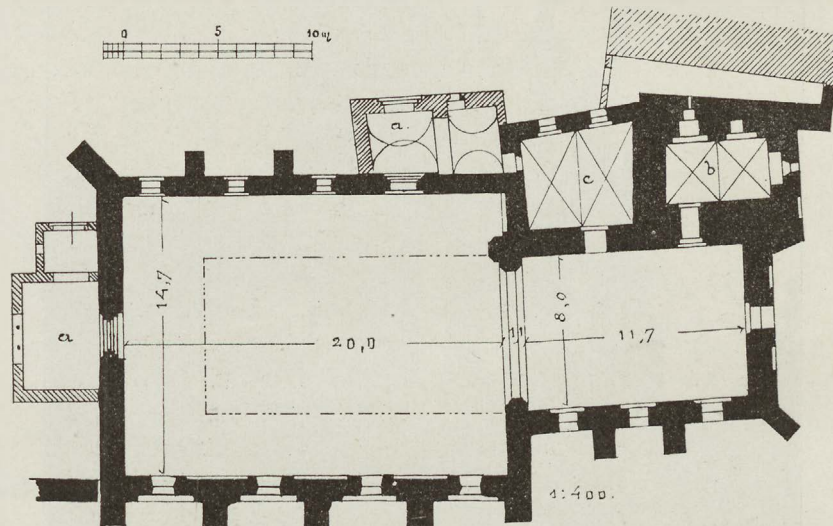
Dt. Eylau. Grundriß der Kirche.
